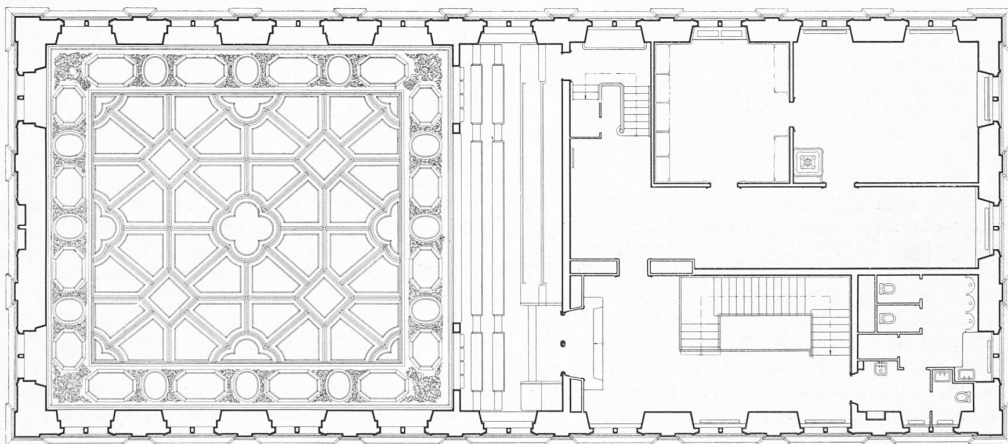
Grundriss zweiter Stock, 1:250. Kantonsratsaal-Tribüne, rechts oben Räume des Kirchenrates
